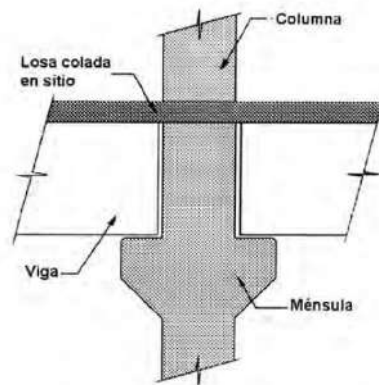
Conexión viga – columna típica del edificio CSUN.
